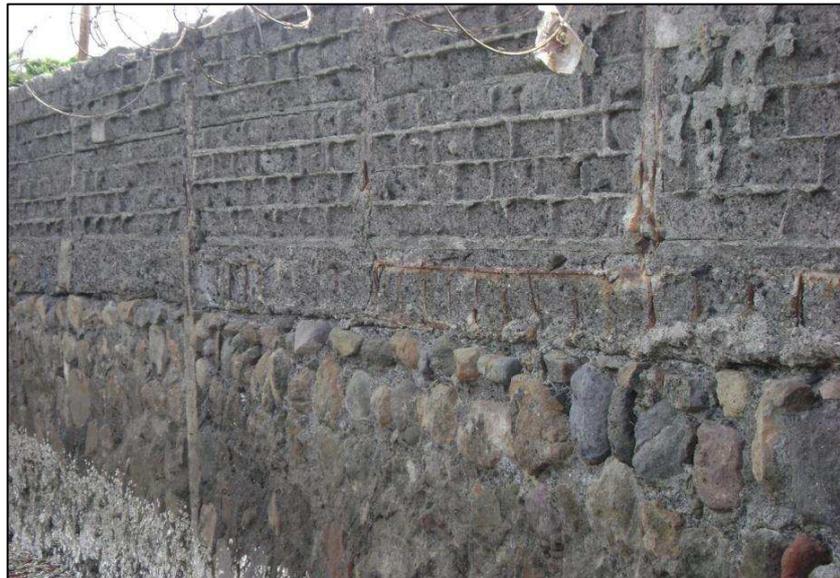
Aspecto de un concreto deteriorado por expansión.
